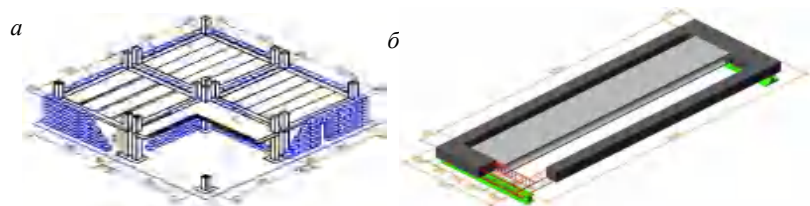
Принципиальная конструкция объемных фрагментов каркаса (а) и плоских фрагментов перекрытия (б)
